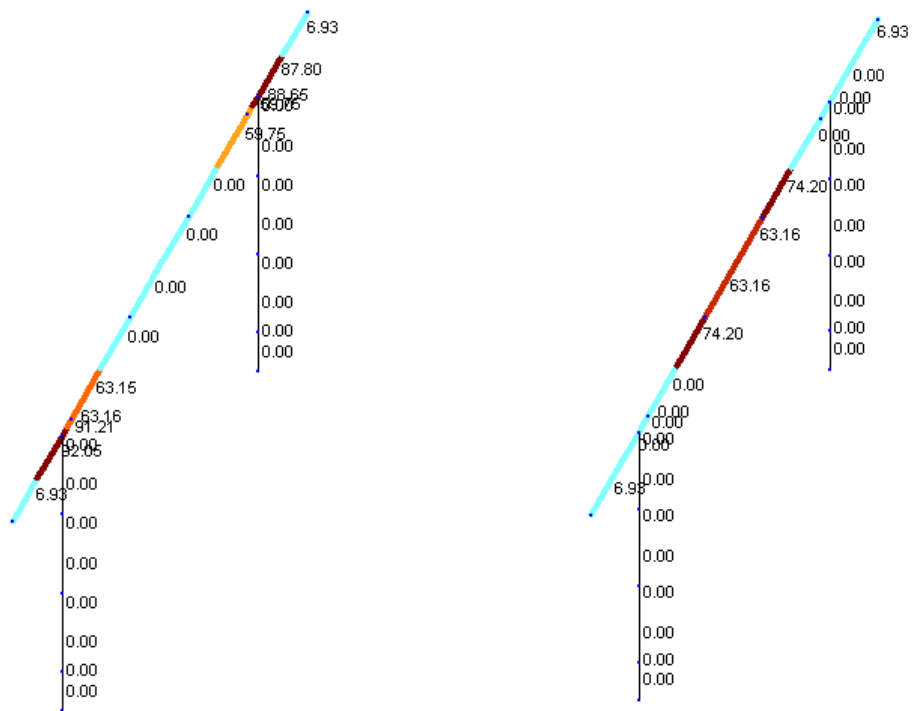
Сумарна площа верхнього і нижнього пояса арматури ригеля опори № 4
